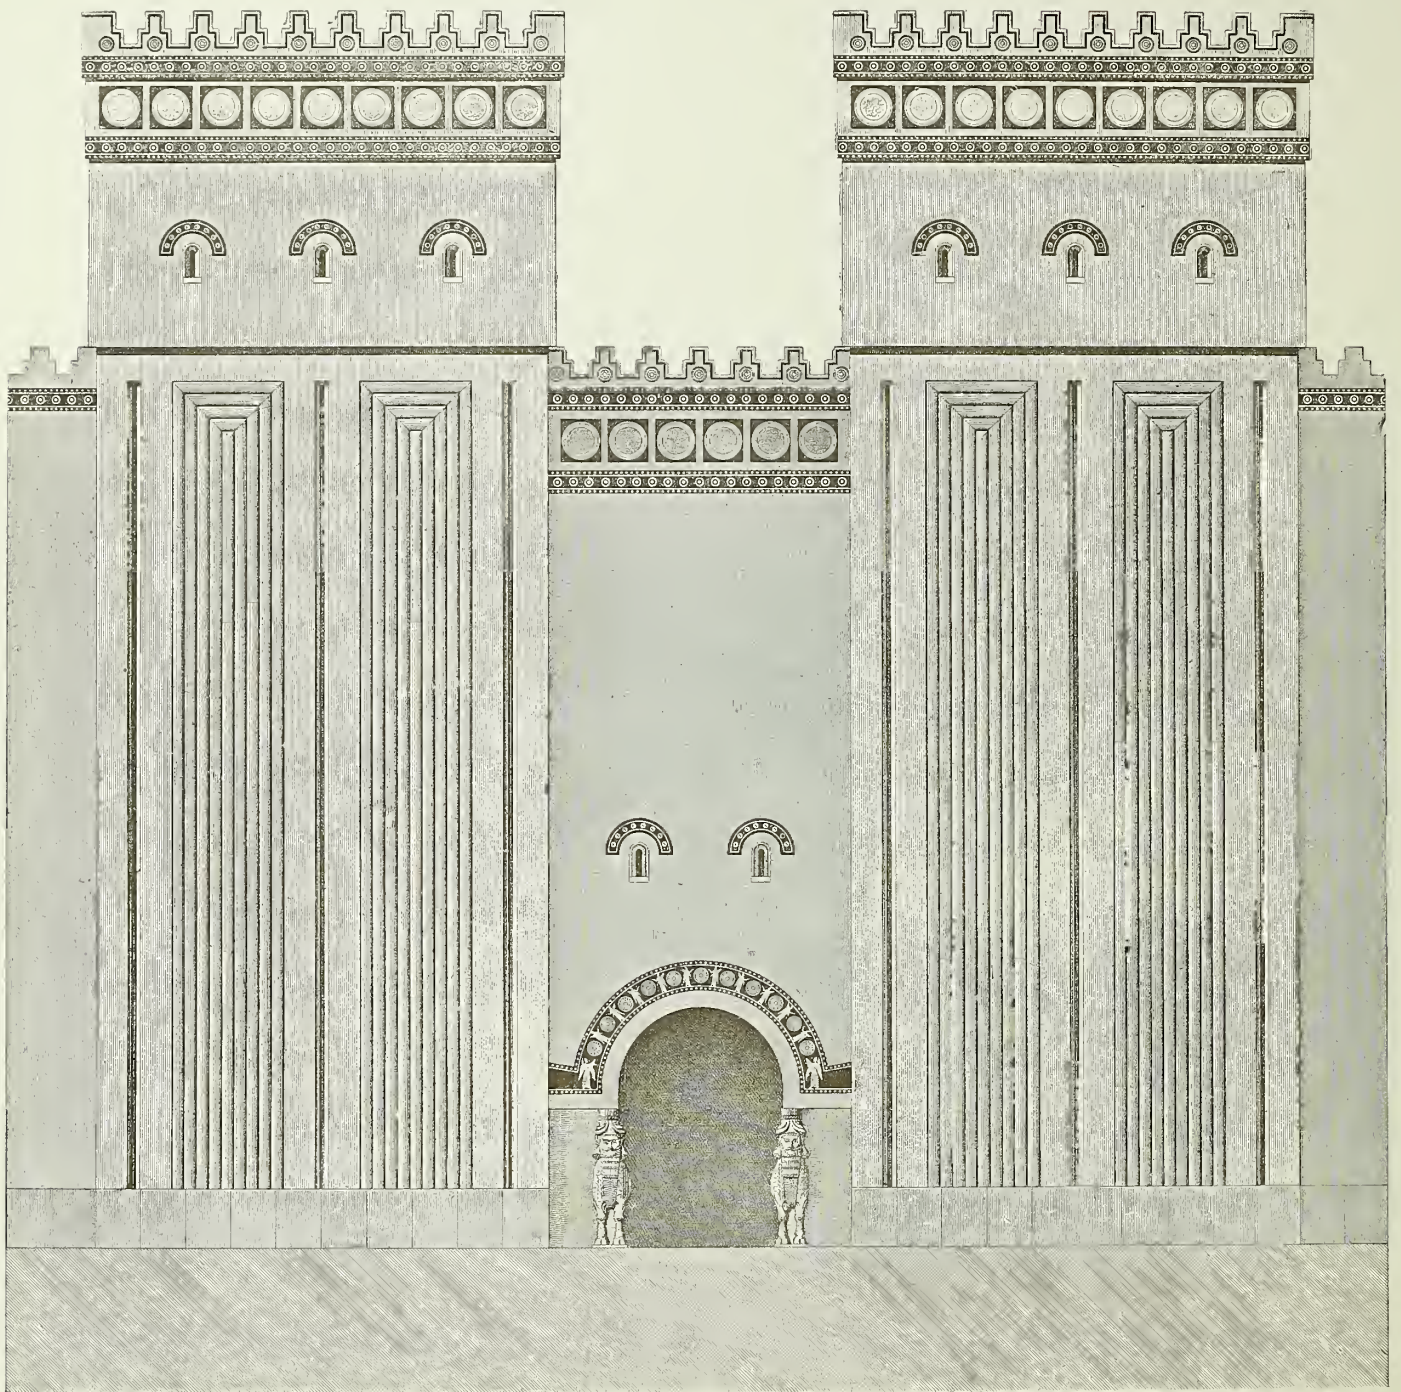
ALZADO GENERAL DE UNA PUERTA DE LA CIUDAD DE SARGÓN (KHORSABAD). — ENSAYO DE RESTAURACIÓN DE THOMAS
